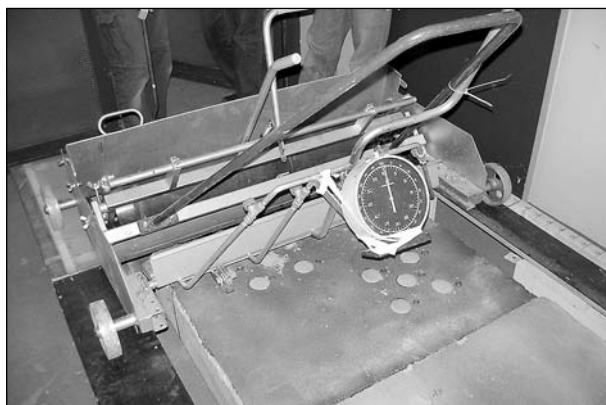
Aufschweiß-Verlegegerät mit Uhr und Maßstab (rechter Bildrand) zur Einhaltung der Vorschubgeschwindigkeit
